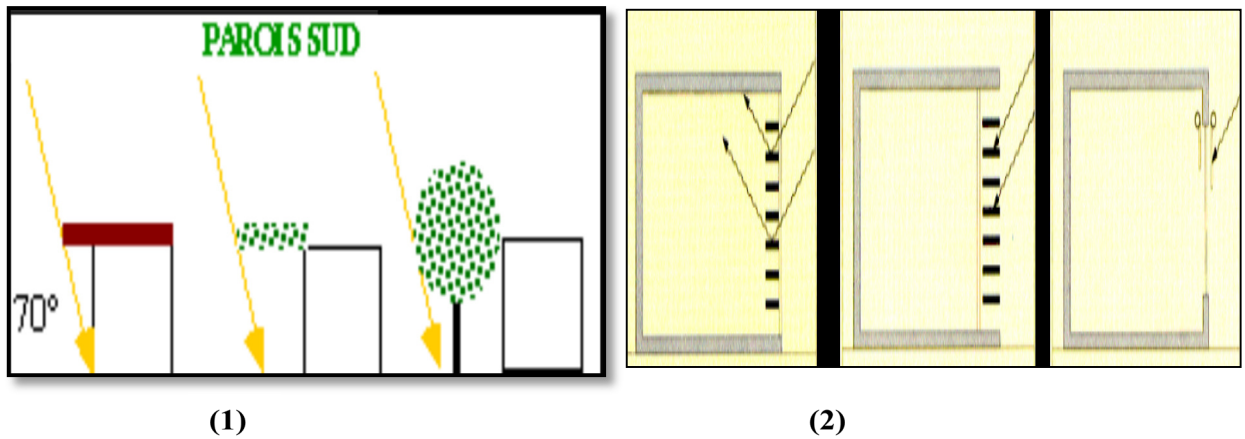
la protection 1- de la façade sud, 2- avec Lamelles à changement de direction
